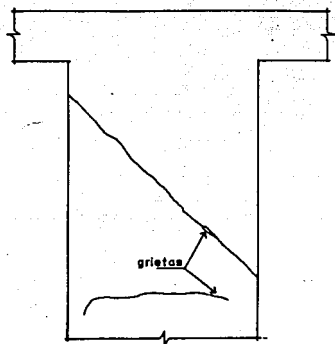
Empleo de morteros plásticos en reparación de grietas (Ref. 15)
